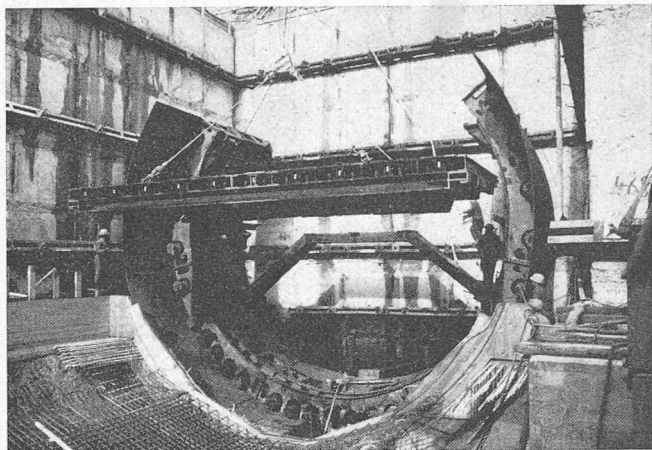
Einsetzen der mittleren Bühne mit aufgebauten Schiebepodesten samt Bruststützen. Gewicht dieses schwersten Einzelstücks: 32 t
